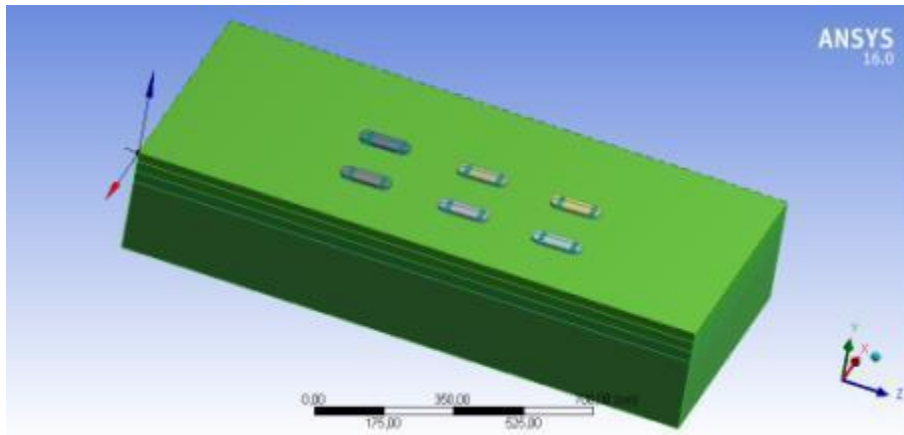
Trois essieux sur une dalle - géométrie en ANSYS (Espacement 1,5m et 6m entre essieux, dalles 7m × 5m).
